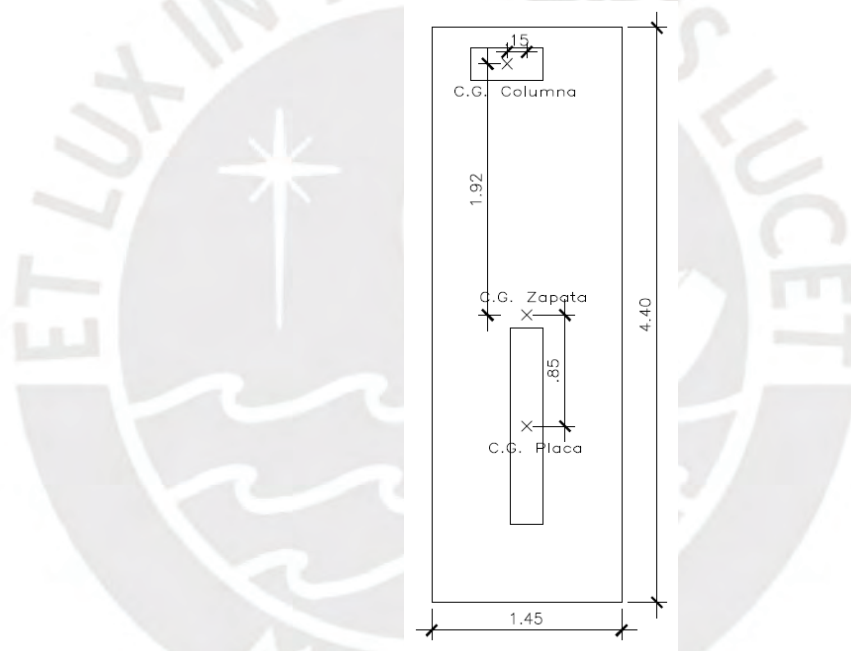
Centro de gravedad de placa, columna y zapata.
